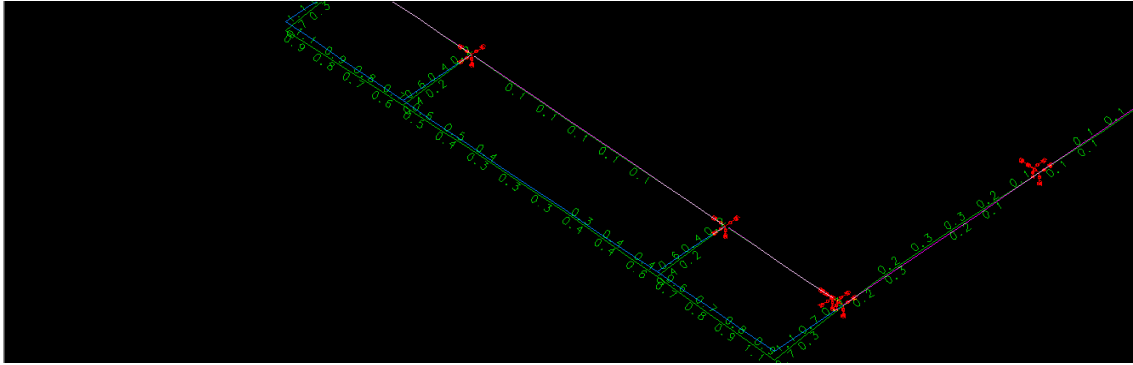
Deslocamentos verticais viga V7 do 2º pavimento, concreto protendido (CAD/TQS).
